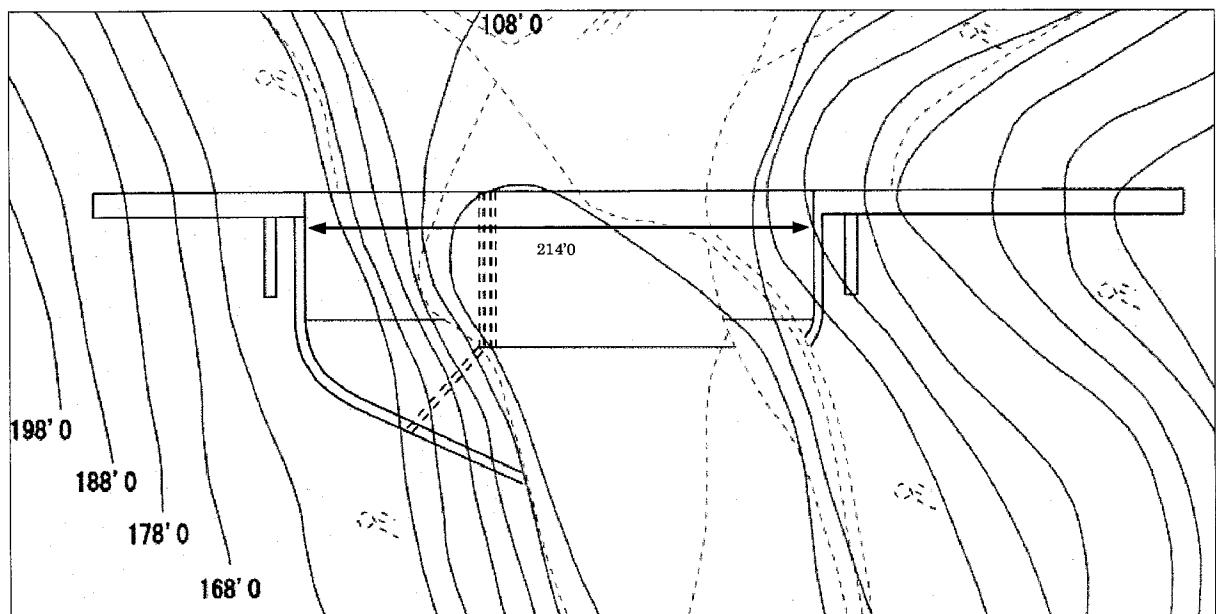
原設計案平面図（高野氏所蔵の原図に修正・加筆）
